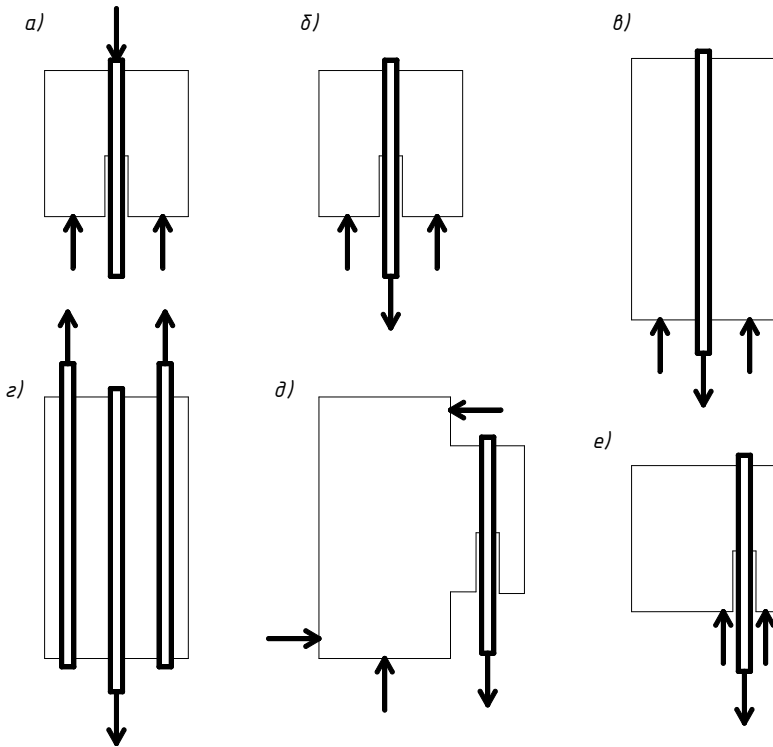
Схеми експериментальних досліджень зчеплення арматури з бетоном при моделюванні реального стану бетону на контактні його зрізу та в довколишній розколюваній обоймі
